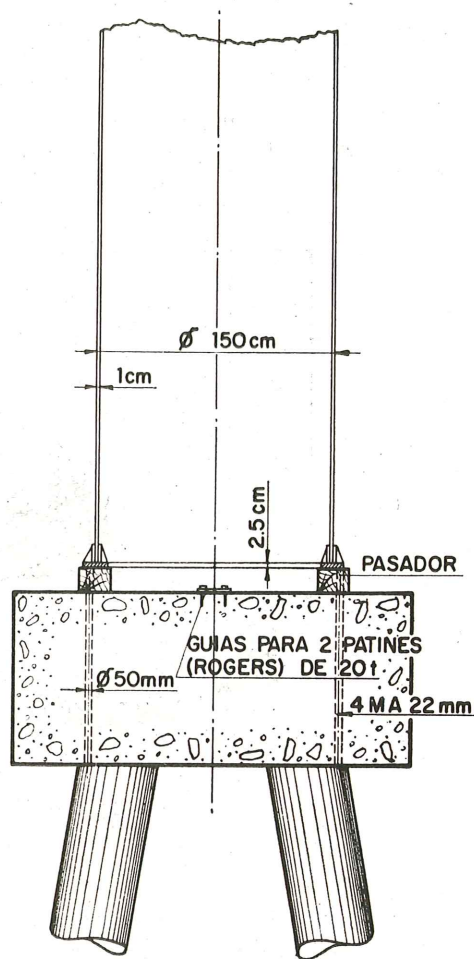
Un soporte tubular de la cimbra con su cimentación.
